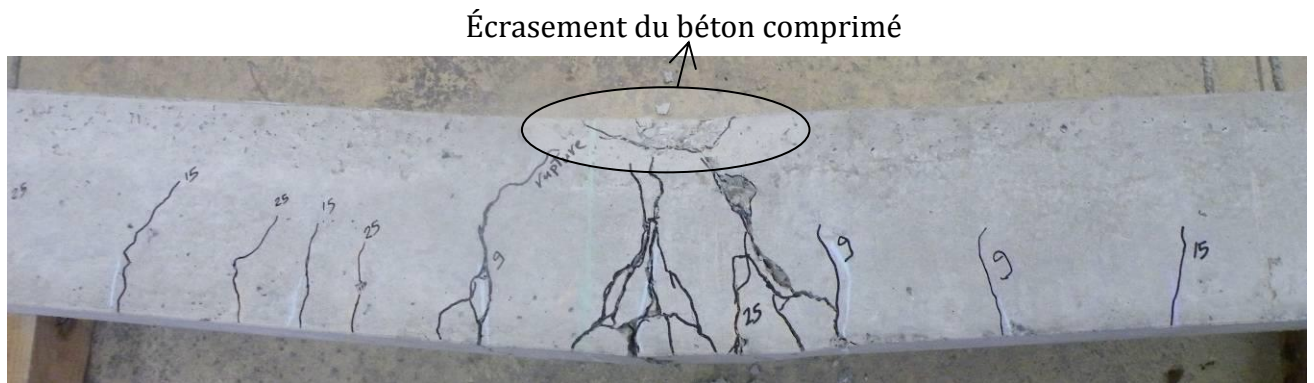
Mode de ruine de la poutre non-réparée B12-0.
